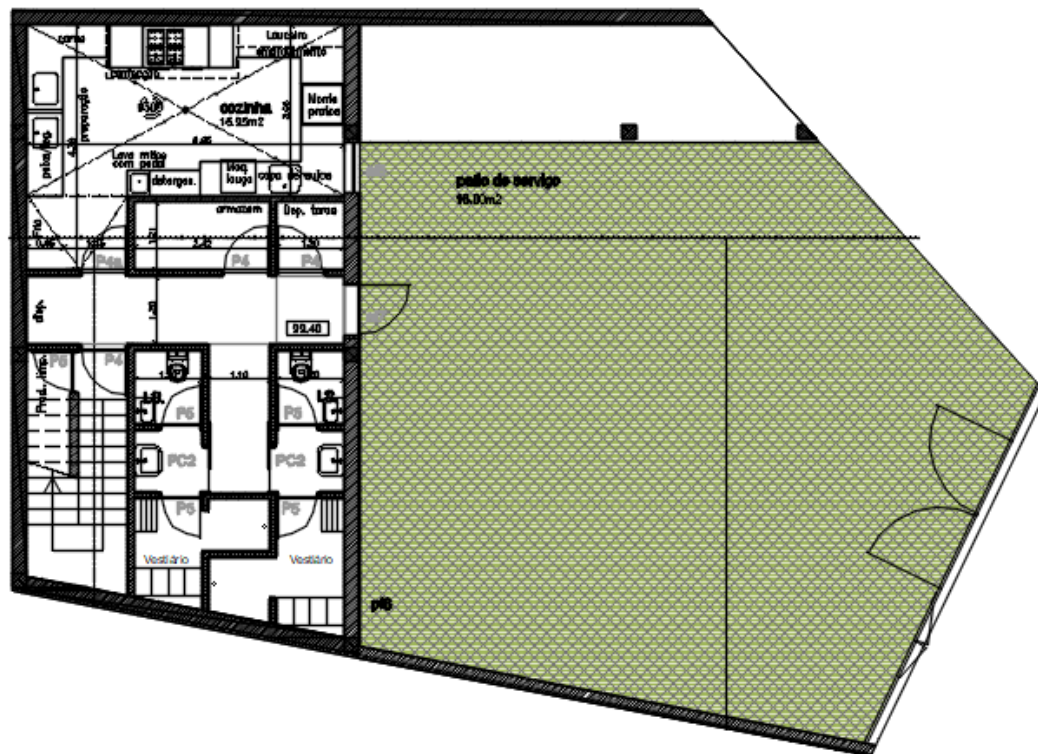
Planta do piso -1, (sem escala) [69]
